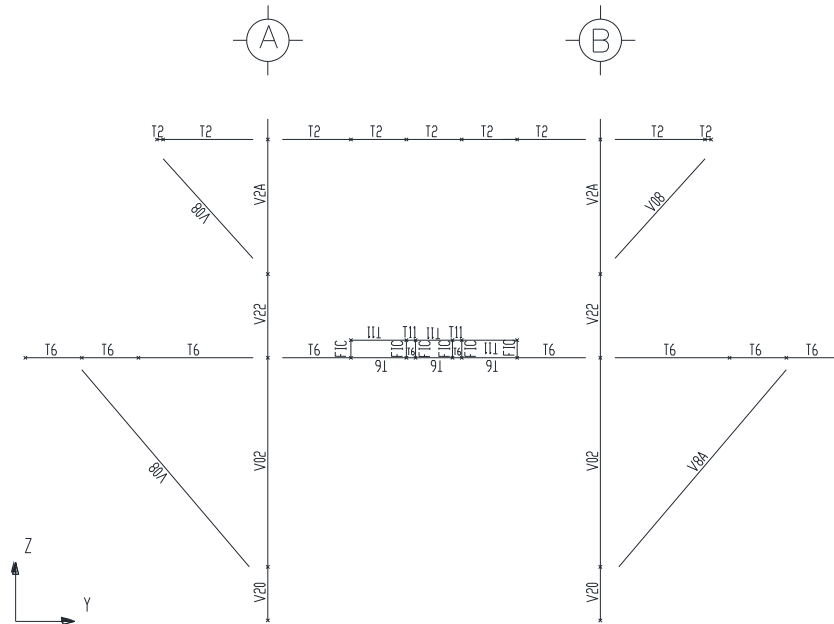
Grupos en marco transversal Eje 1, superestructura
